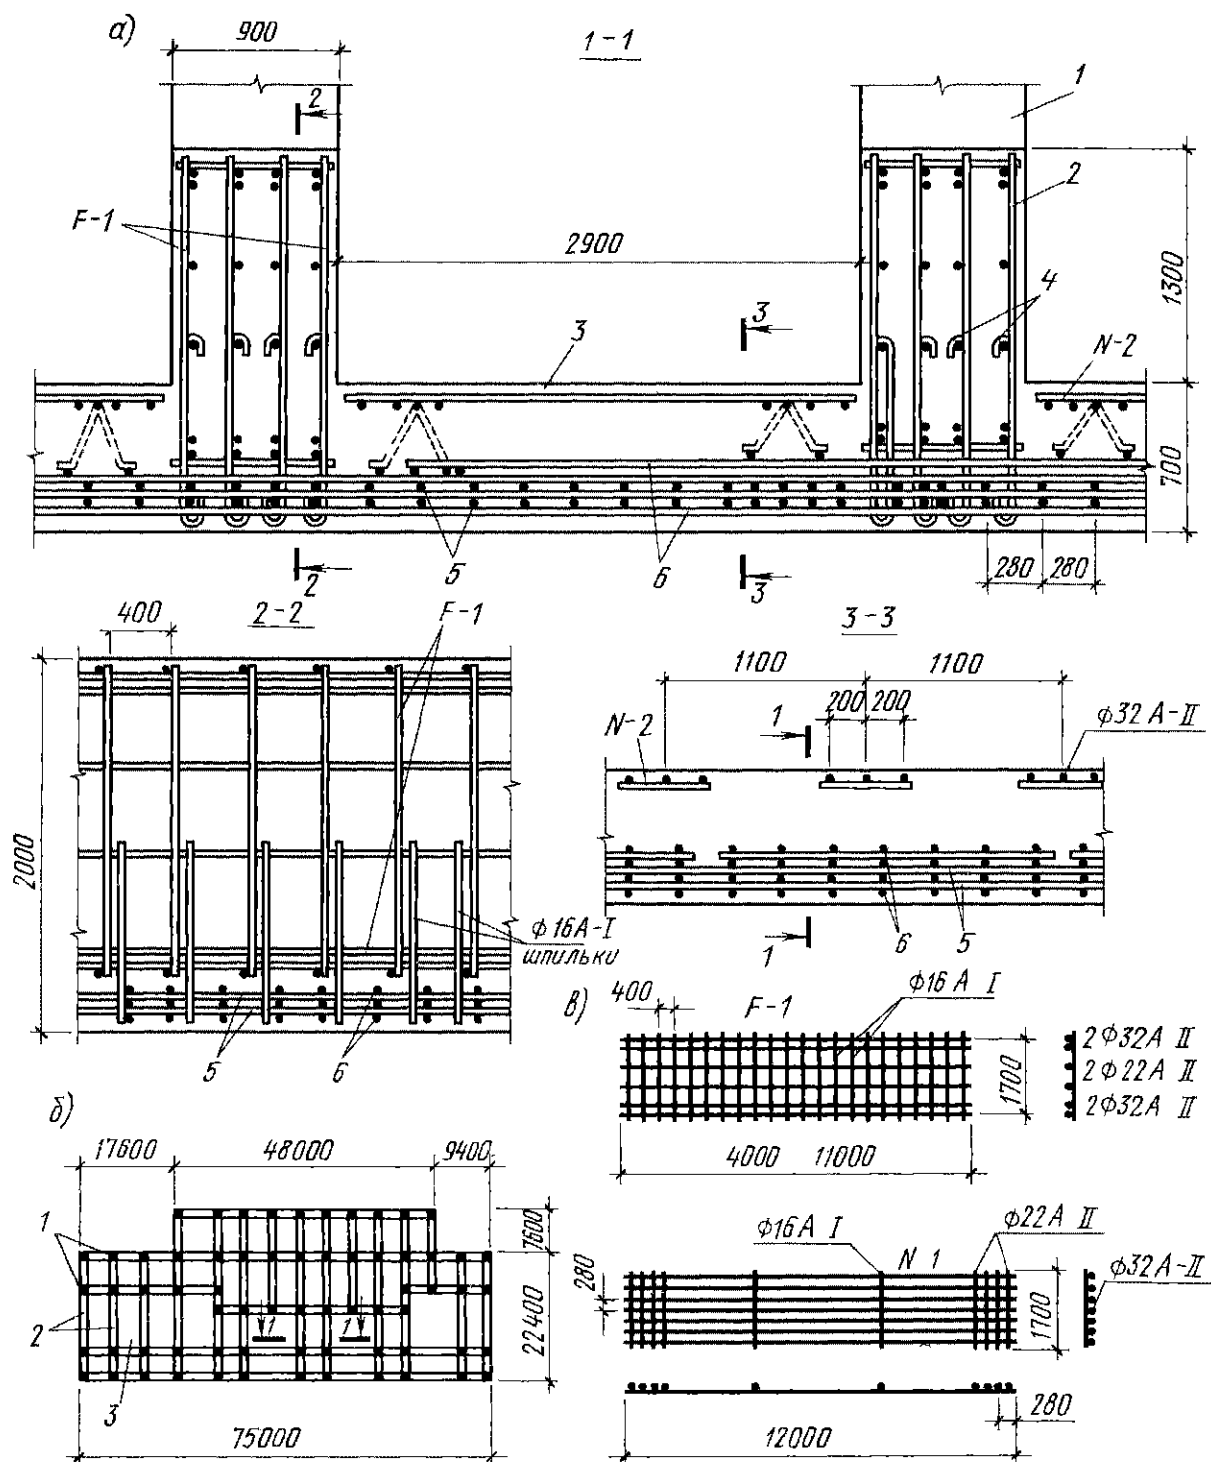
Пример армирования сплошного плитно-балочного фундамента
